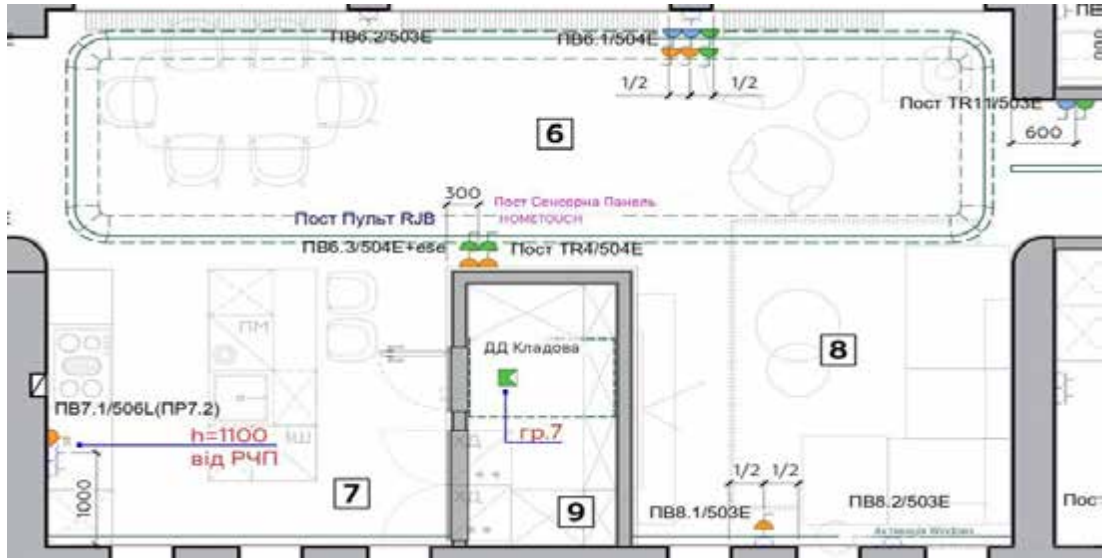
План розкладки постів керування з ідентифікаторами лаунж столова
